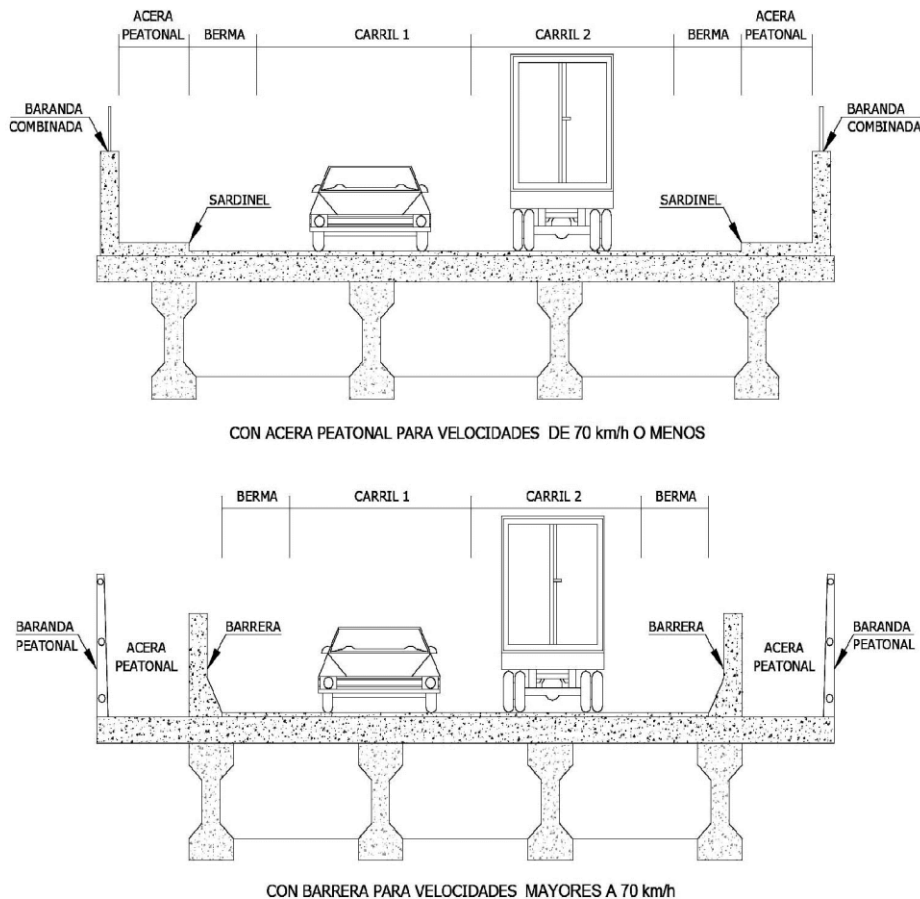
Elementos en la sección transversal de un puente (Fig. 2.1.4.3.2-1, Manual de Puentes, MTC-Perú)
